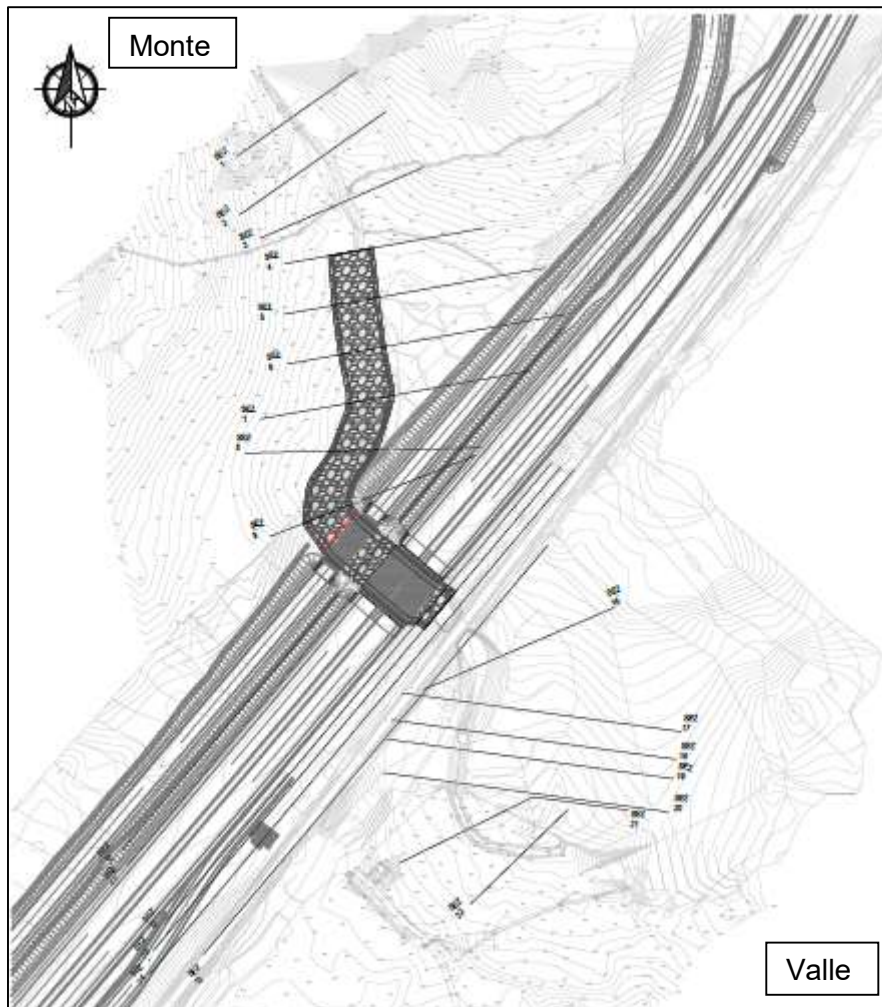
Stralcio planimetrico dello stato di progetto con inquadramento dell'attraversamento sul Riu Mannu tramite ponticello idraulico L=23.2 m – PO02 SU S20 al km 122+339.50.
